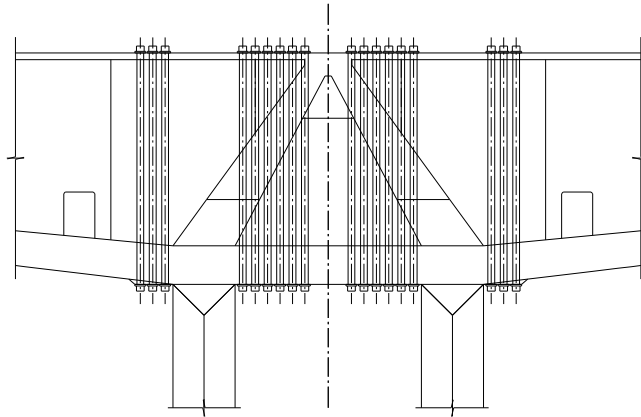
Pretensado vertical en la sección transversal de la pila, dispuesto para compensar la pérdida de armado en las paredes inclinadas de los diafragmas durante las perforaciones necesarias para pasar los cables del pretensado exterior.
